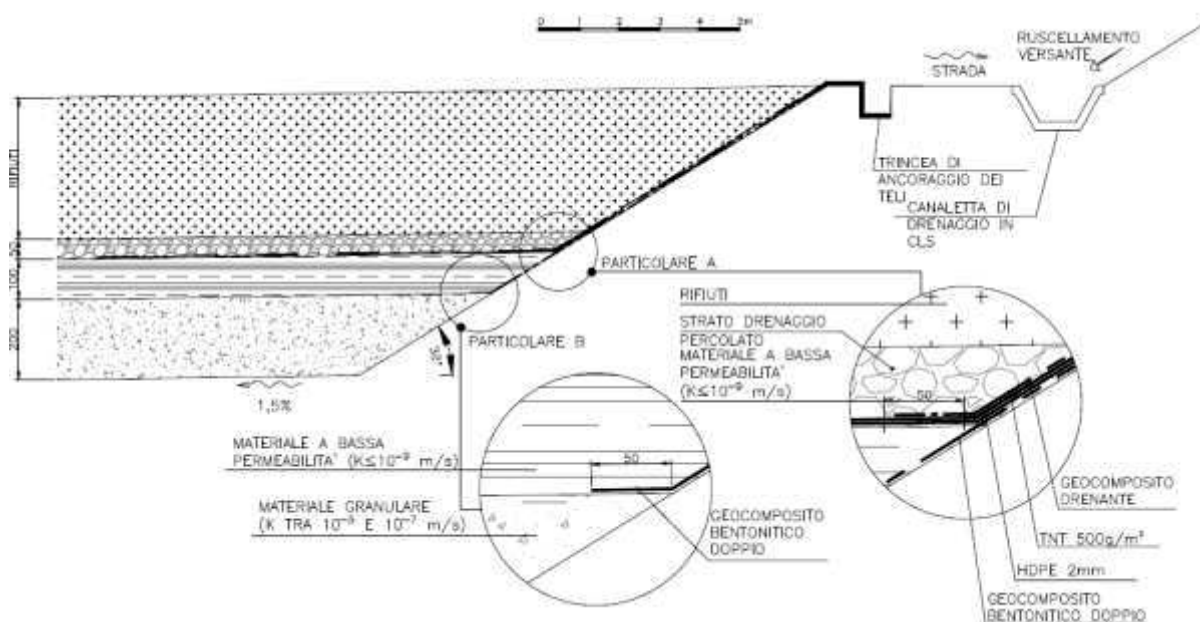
Sistema di impermeabilizzazione della parete e del fondo
